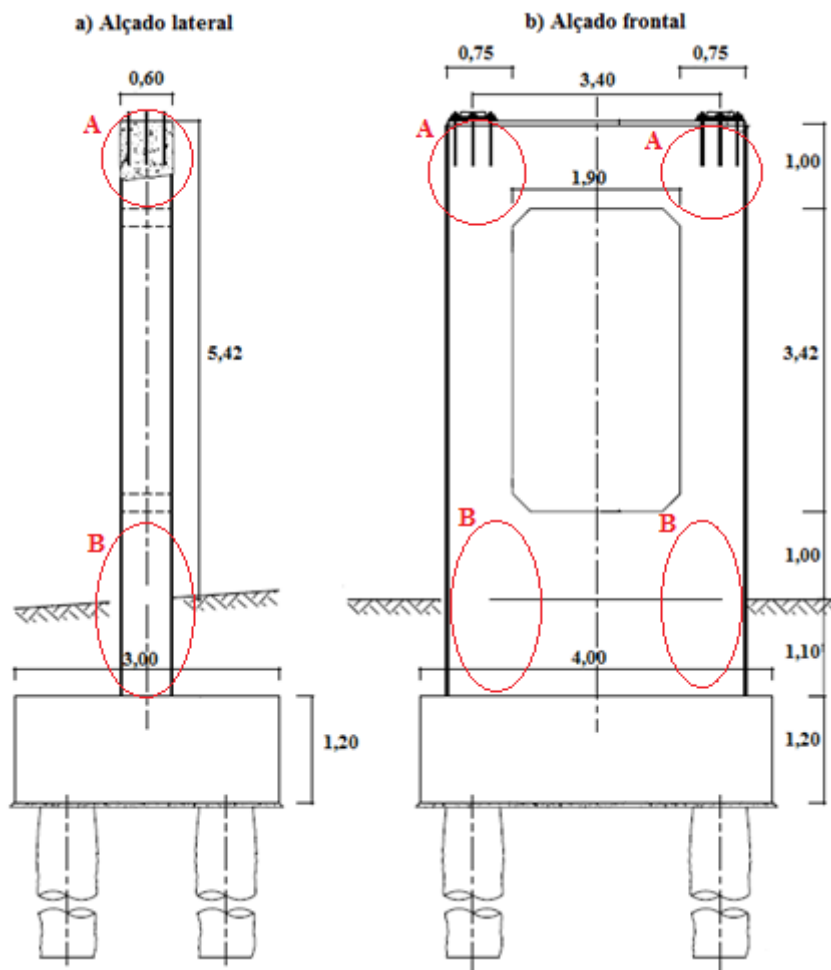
a) Alçado lateral do pilar P2; b) Alçado frontal do pilar P2 [25].
